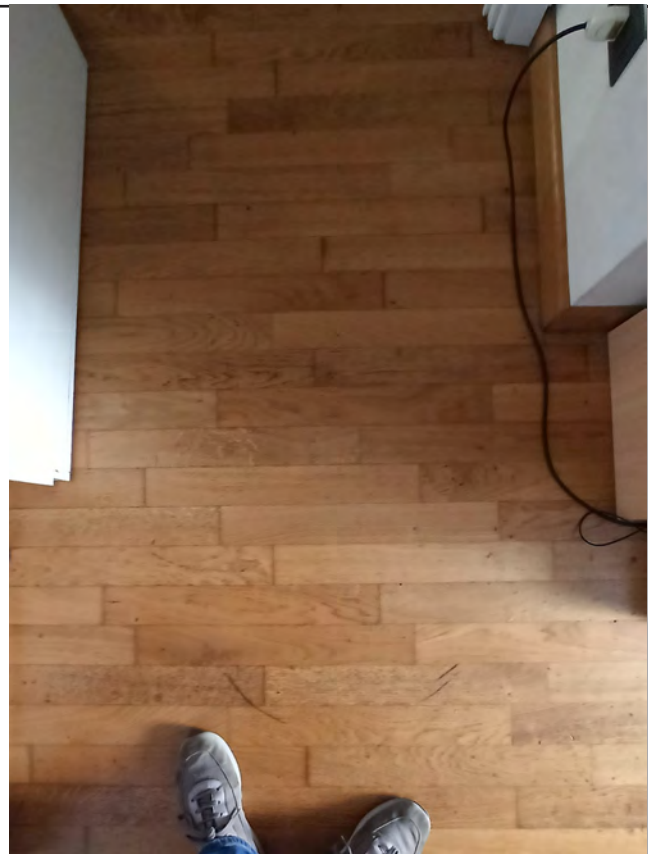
dettagli - la pavimentazione del bagno mista in parquet e grès
